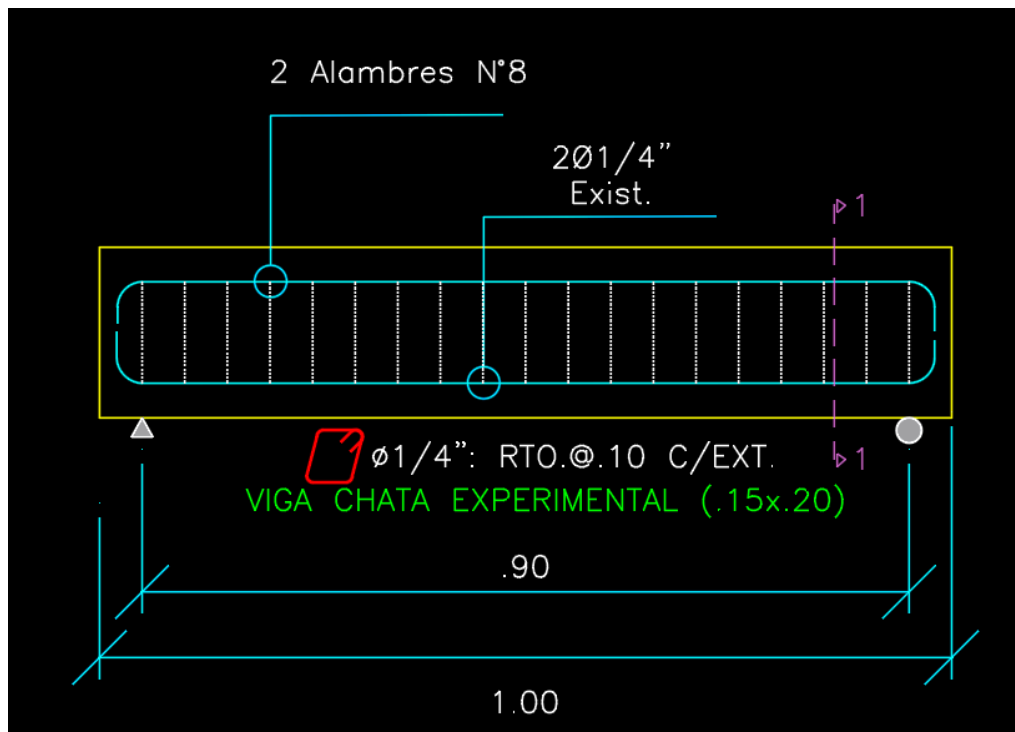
Corte en espécimen prismático experimental, diseñado para comportarse como una viga simplemente apoyada.
